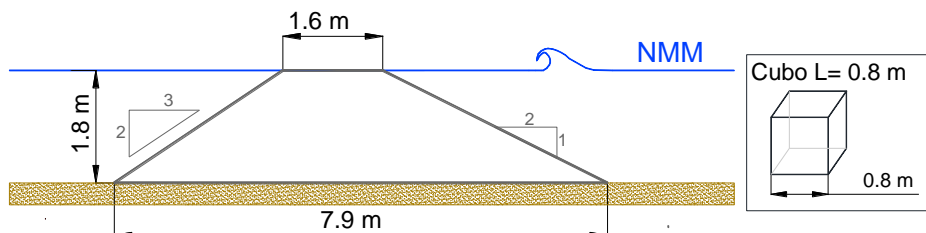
Sección transversal de las estructuras diseñadas para proteger el litoral del "Hotel Sandos Caracol Eco Resort".
